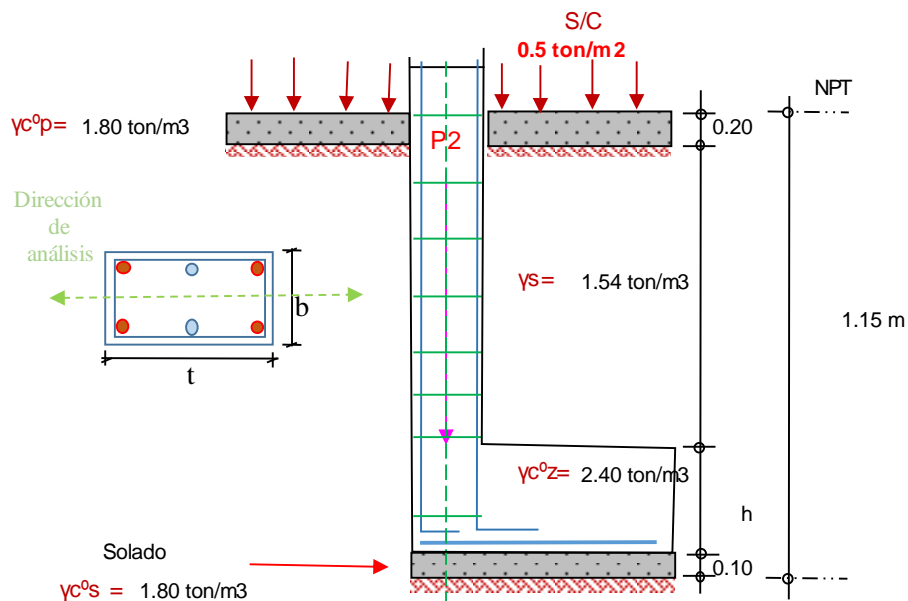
Detalle de zapata excéntrica (Estructura 2).
